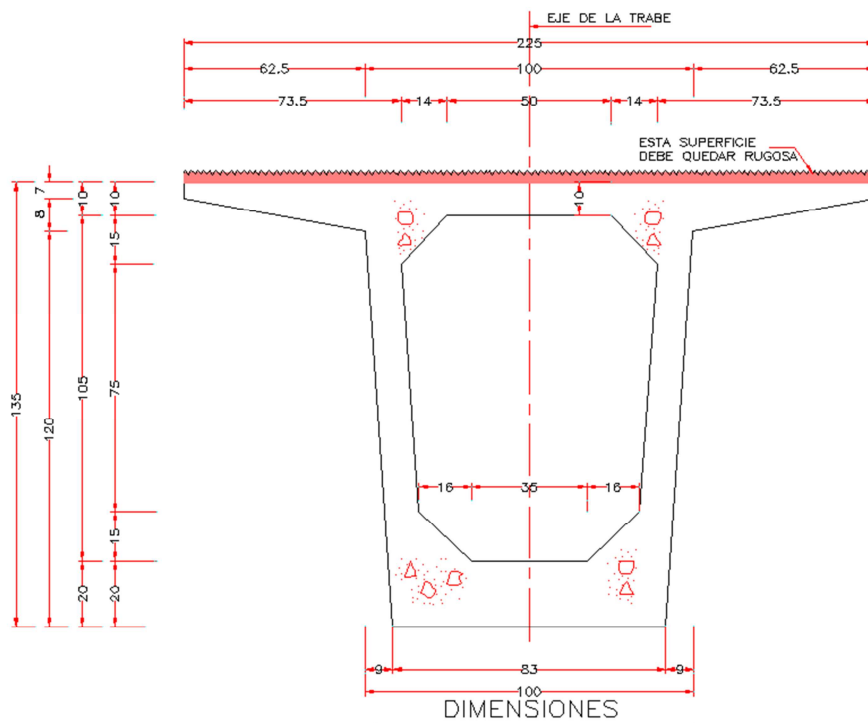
Sección Transversal de la estructura al centro del claro
